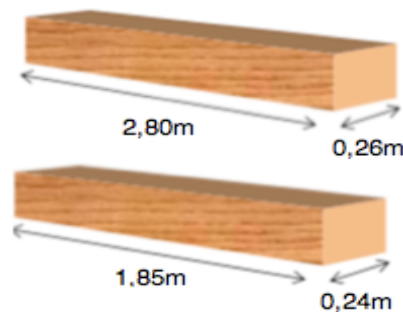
Travessas de madeira [adaptado de Silva, 2004]
